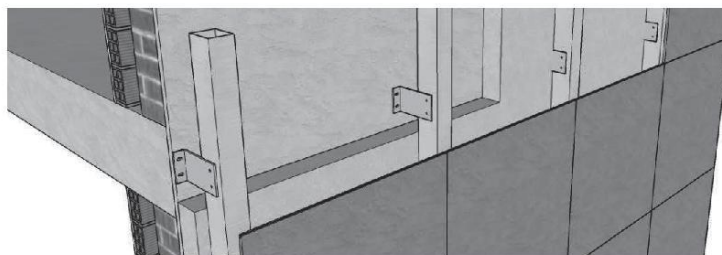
La subestructura de la fachada ventilada se fija a los frentes de forjado mediante anclajes de aluminio
